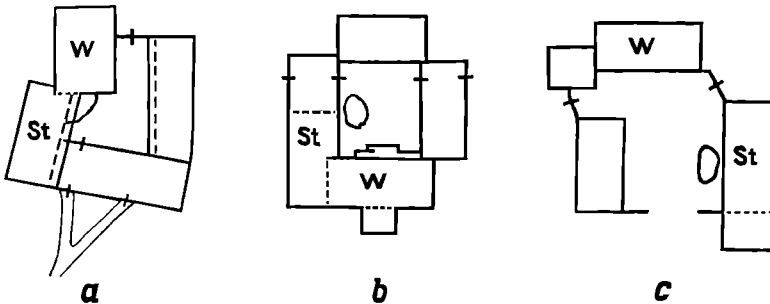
Beispiele lockerer Gehöftegrundrisse, rd. 1:1250, alle ungefähr nach S orientiert. *a* „Wofler“, Amesschlag im Mühlv. *b* „is Jeitler“, *c* „Piefing“, beide in der Gemeinde Feistritz am Wechsel. *W* Wohnhaus, *St* Stall. — Bei allen drei Grundrissen machen sich Bodenunebenheiten geltend.
